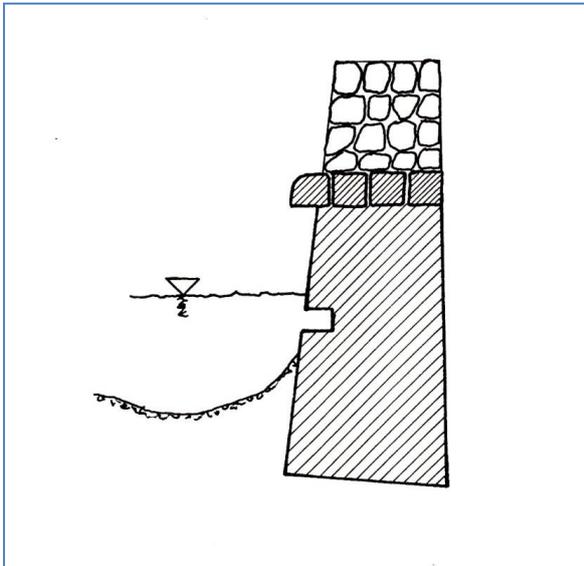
Fischfreundliche Grundschwelle in Beton oder Zementmörtelmauerwerk mit Fischunterstand und abgerundeter Kronenauskrragung (MERWALD, 1994)
